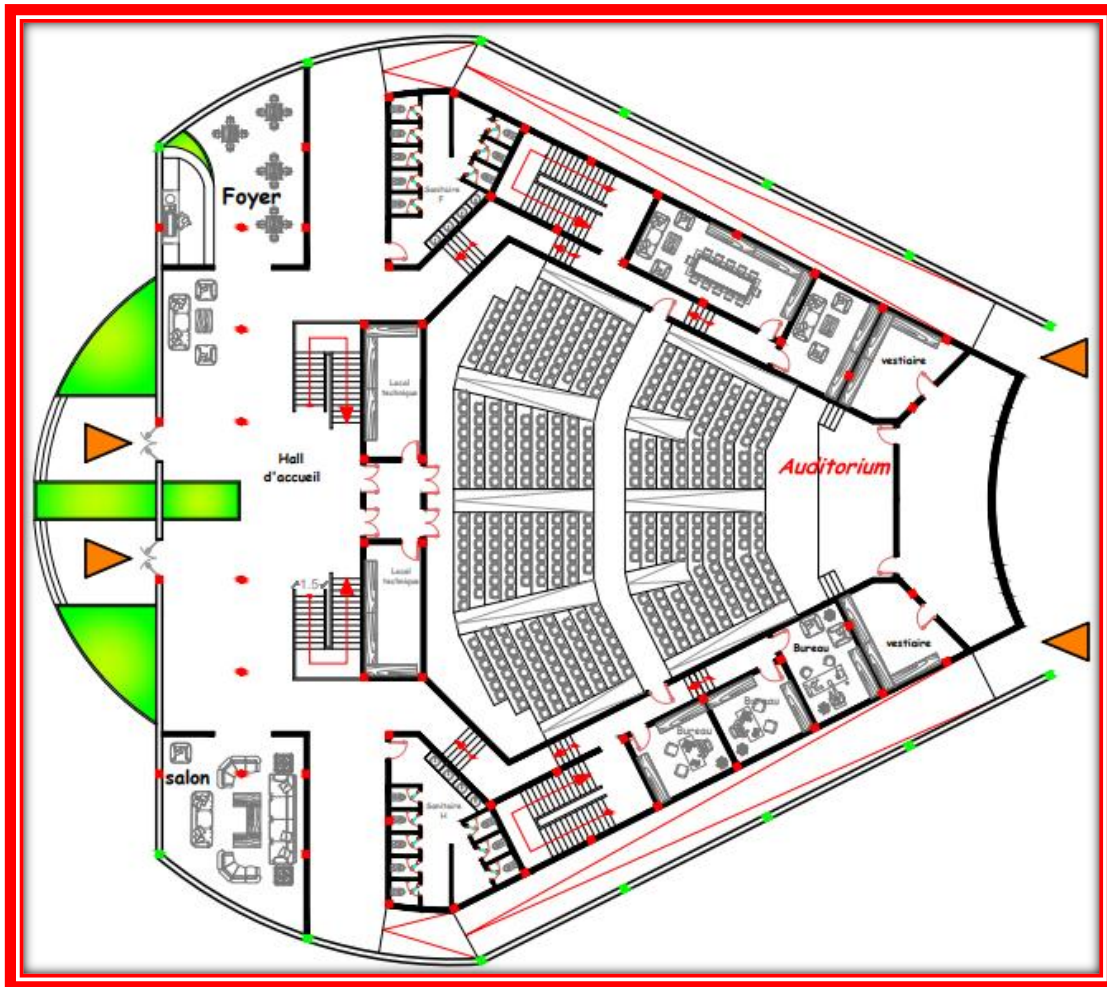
plan de niveau 1 (l'auditorium) / source: auteur
